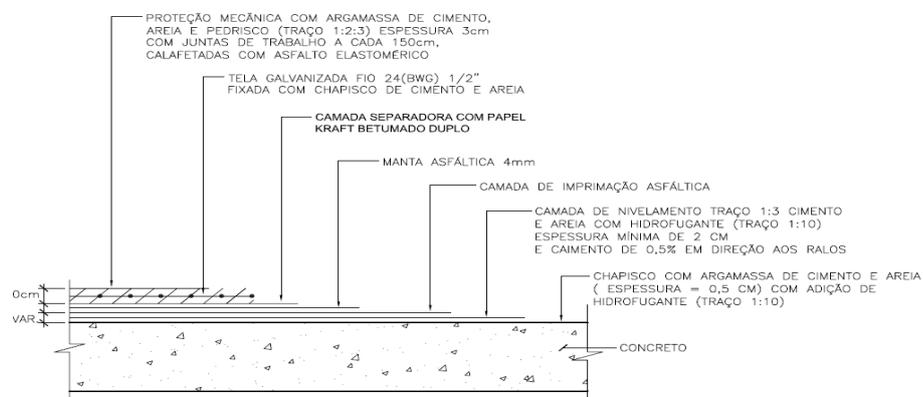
Detalhe da impermeabilização da laje de cobertura do prédio do bloco “O”
